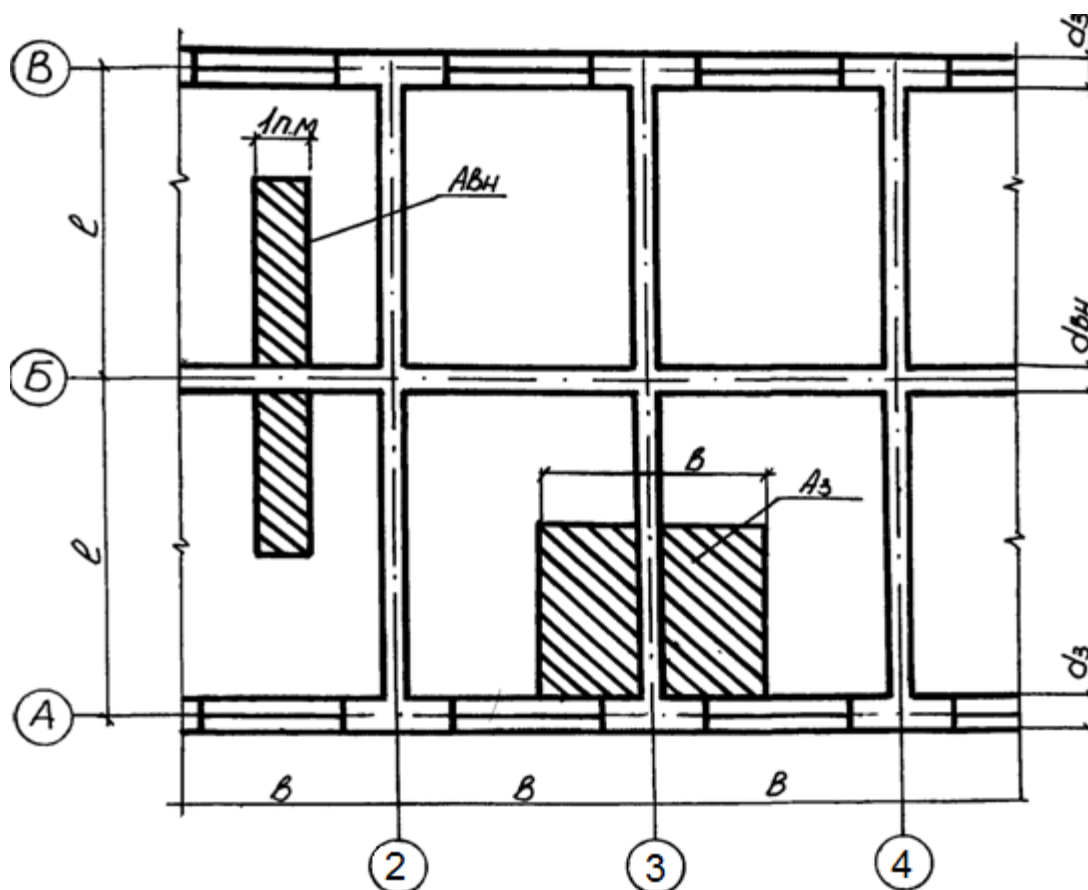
Вантажні площі для розрахункових фундаментів
